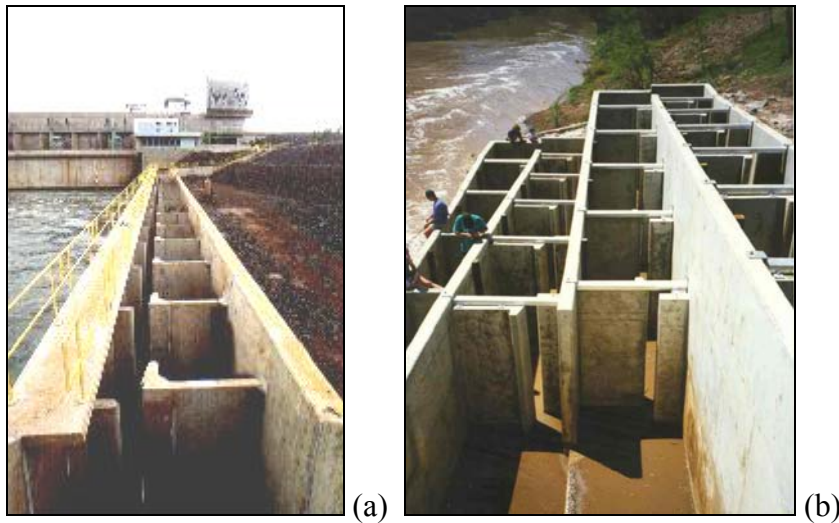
Exemplos de escadas para peixes com ranhuras verticais: (a) UHE Igarapava (Fonte: www.uhe-igarapava.com.br); (b) em construção na Austrália (Fonte: Pena, 2004).
